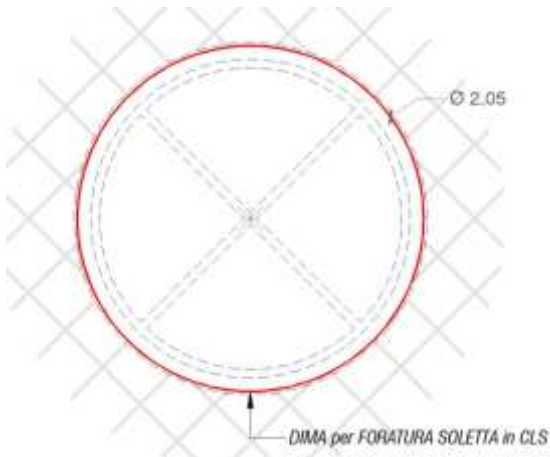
Installation sur dalle de béton - gaine pouvant être inspectée par une trappe
